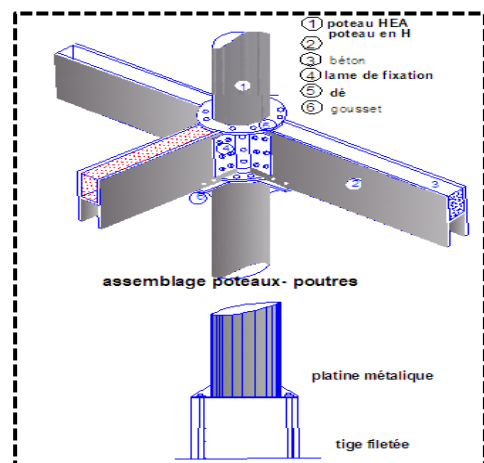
détail d'encrage poteau métallique poteau en béton armé
